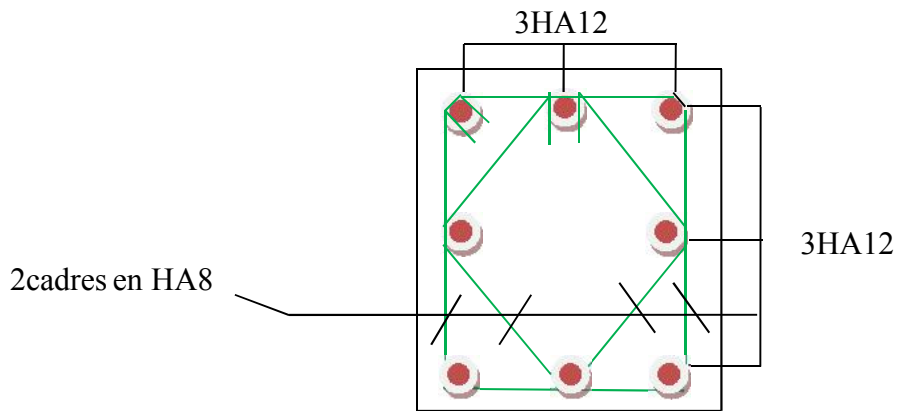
Coupe verticale sur poteau (30x30)cm²
